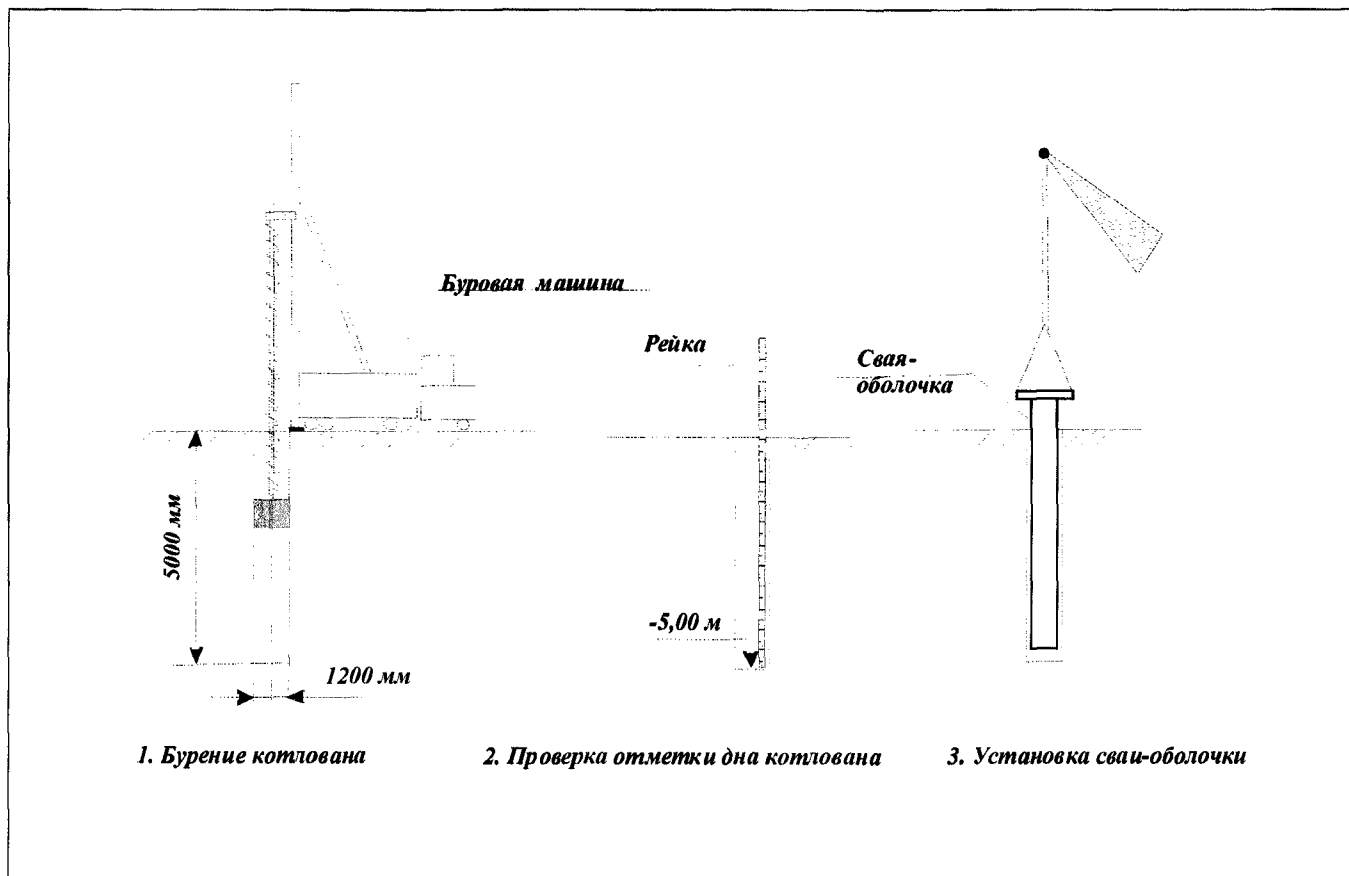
Схема бурения котлована и монтаж свай - оболочки
